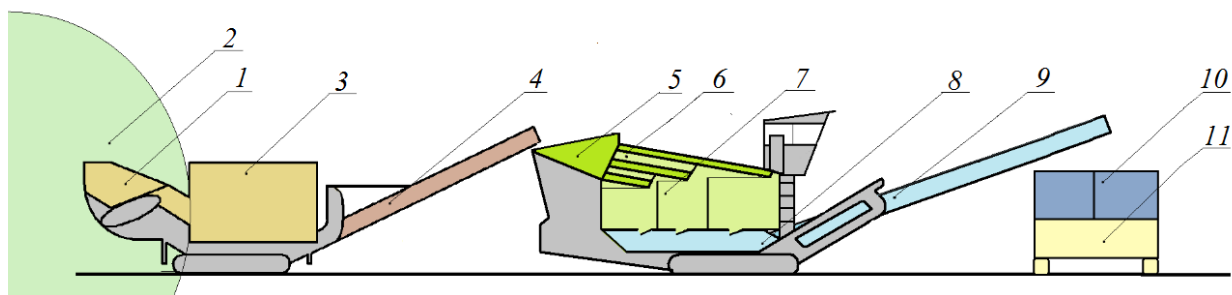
Комплекс перерабатывающего и транспортного оборудования в забое
